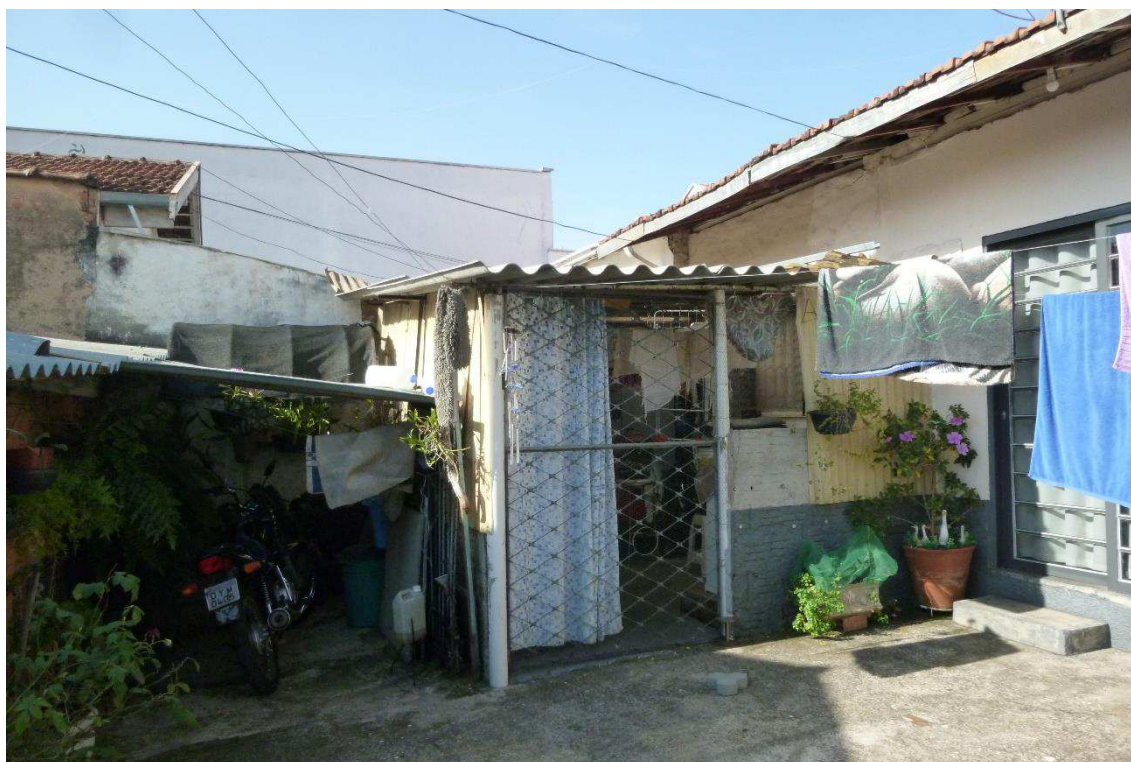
Vista de um rancho -cobertura-, de acabamento rústico anexo à casa dos fundos.
